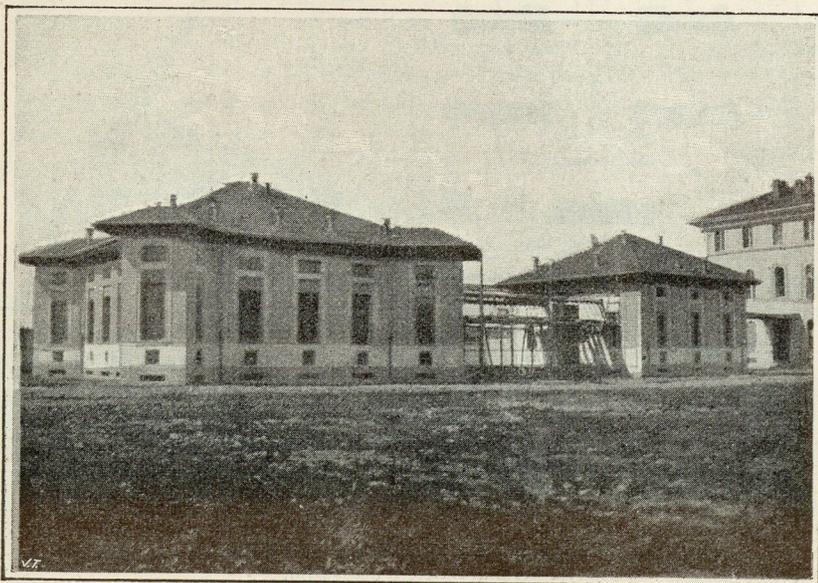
Padiglione di accettazione e camera di osservazione.
